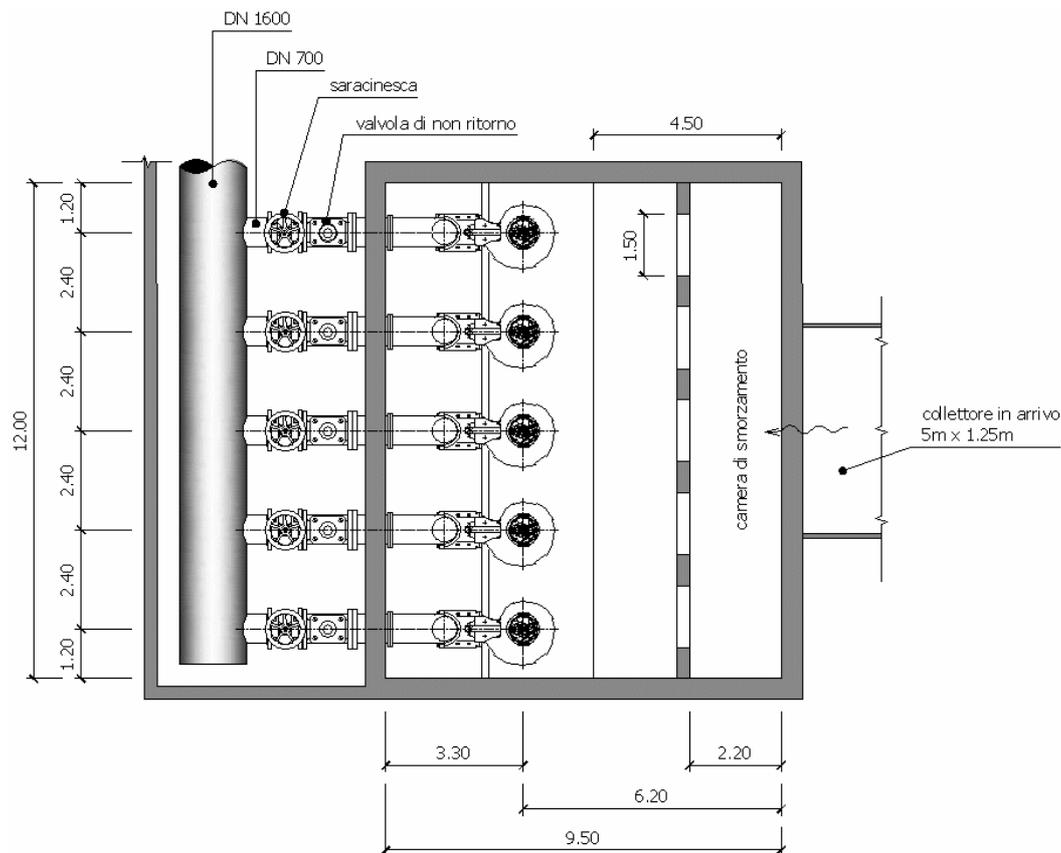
Idrovora da 6 m³/s. Pianta.
